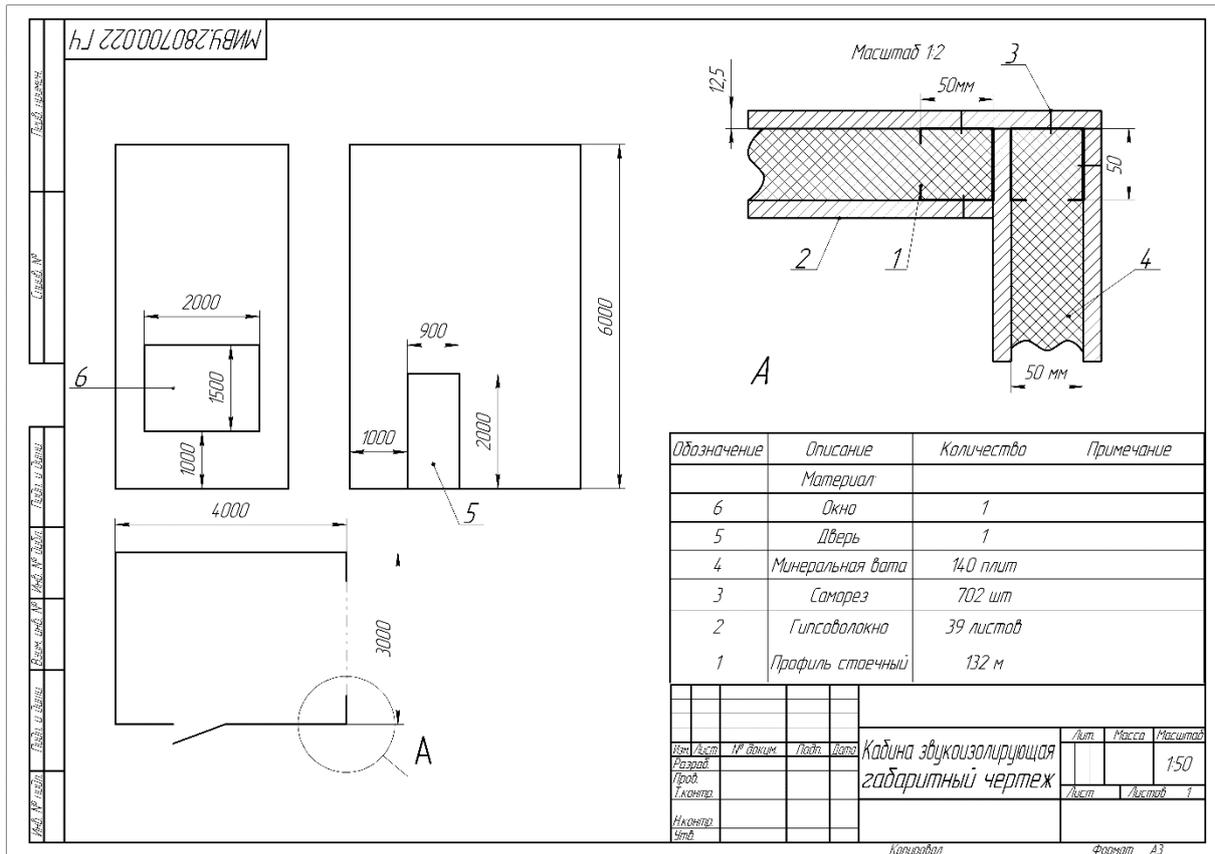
Кабина звукоизолирующая. Габаритный чертёж
